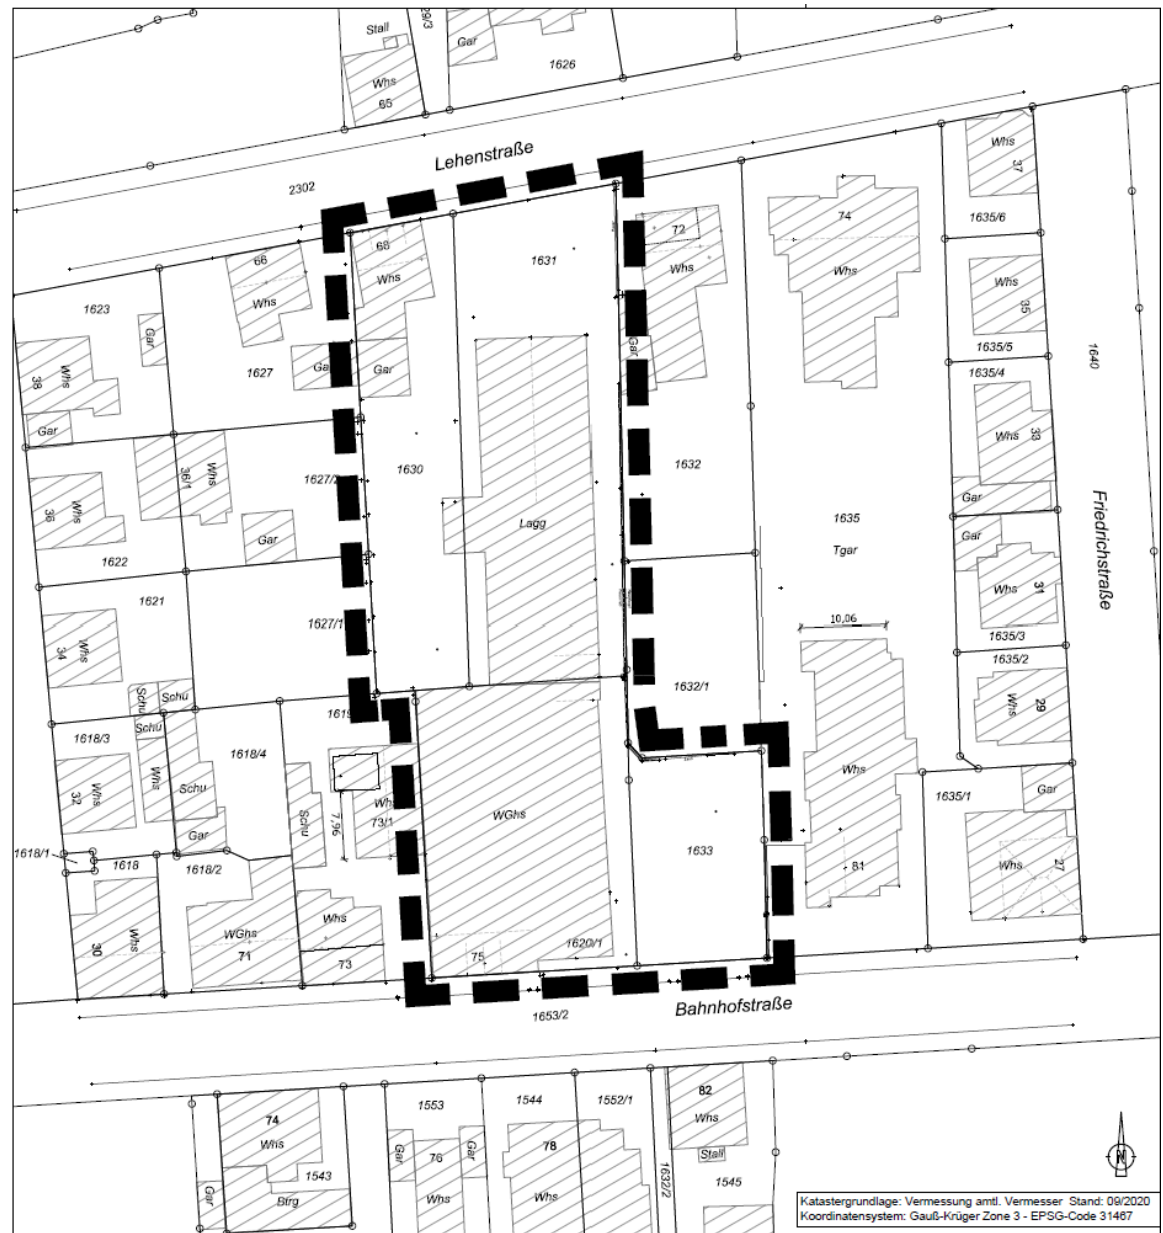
Lageplan mit Geltungsbereich, Project GmbH, 07.06.2021 (o.M.)
